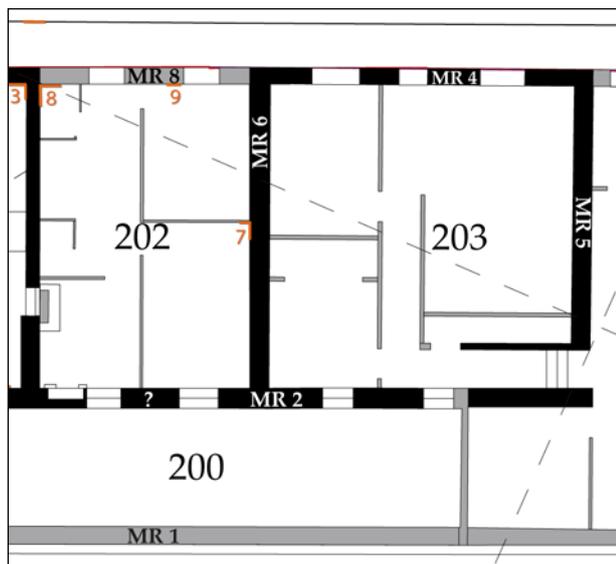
Plan de localisation des faits de l'espace 203 (DAO M. Panneau, S. Ranchin)
